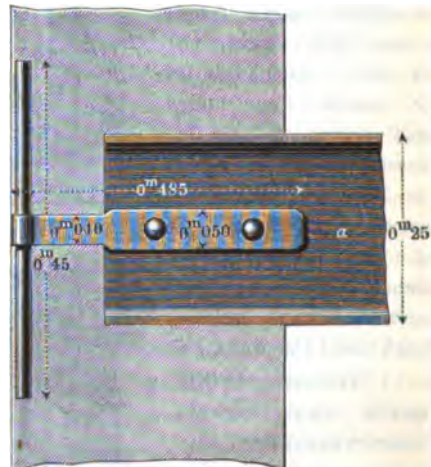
zeigt die Grundrissanordnung einer Pariser Zwischendecke, wie sie jetzt bei allen Privat- und öffentlichen Gebäuden fast ausschließlich
